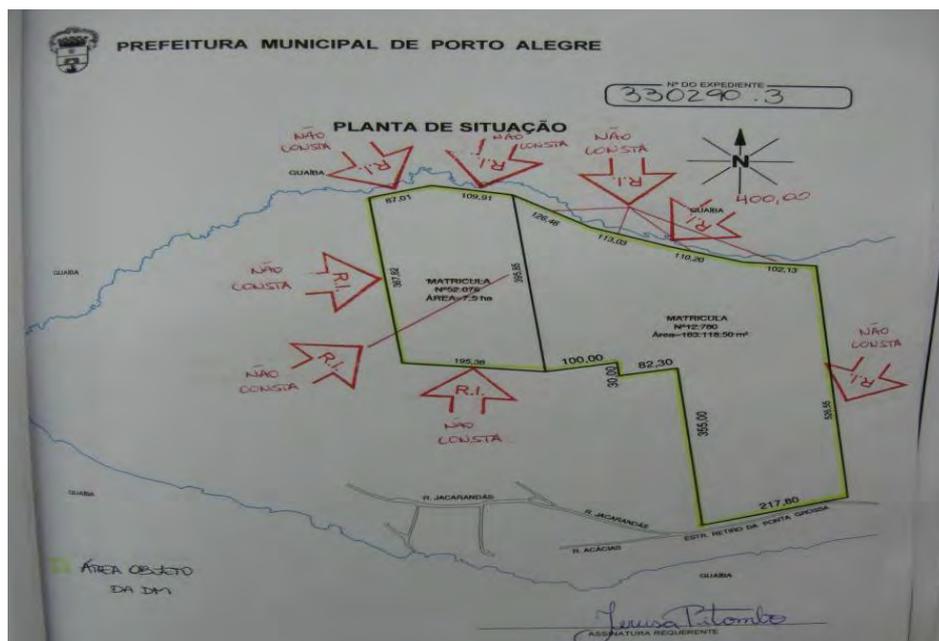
Planta dos terrenos do empreendimento. Fonte: SPM, 2011.
